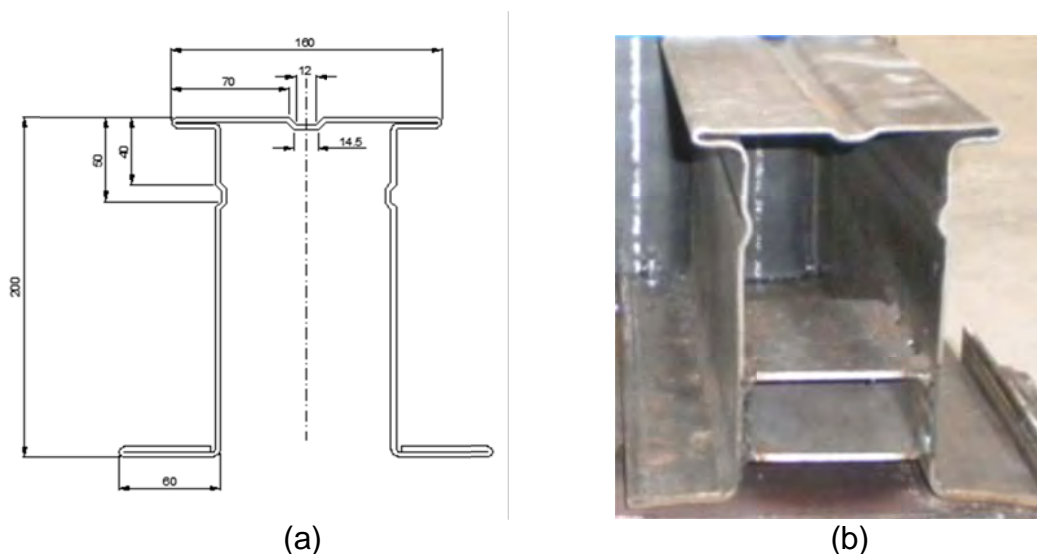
a) Caratteristiche geometriche della trave ORP 200/3mm oggetto di prova; b) Immagine della trave dalla testata
